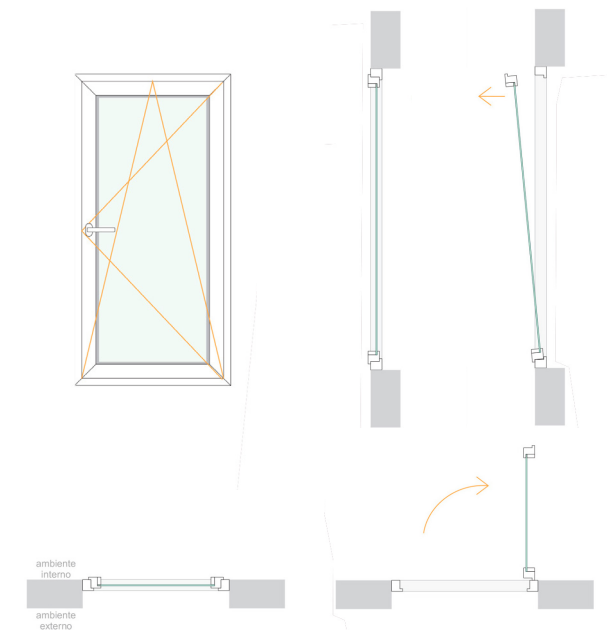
Janela oscilo batente em vista frontal, corte e planta.
